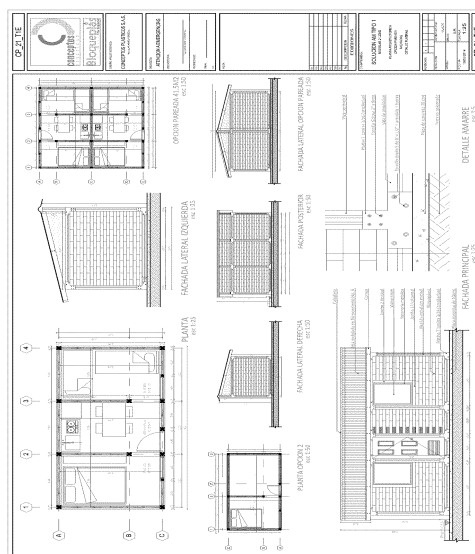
Plantas arquitectónicas vivienda de emergencia. Fuente: bloque plas
